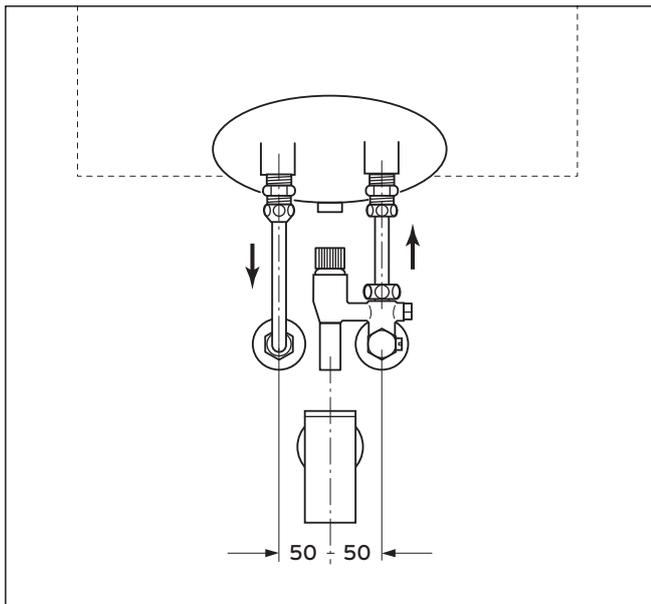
Vista frontal en el sistema estanco (dimensiones en mm)
